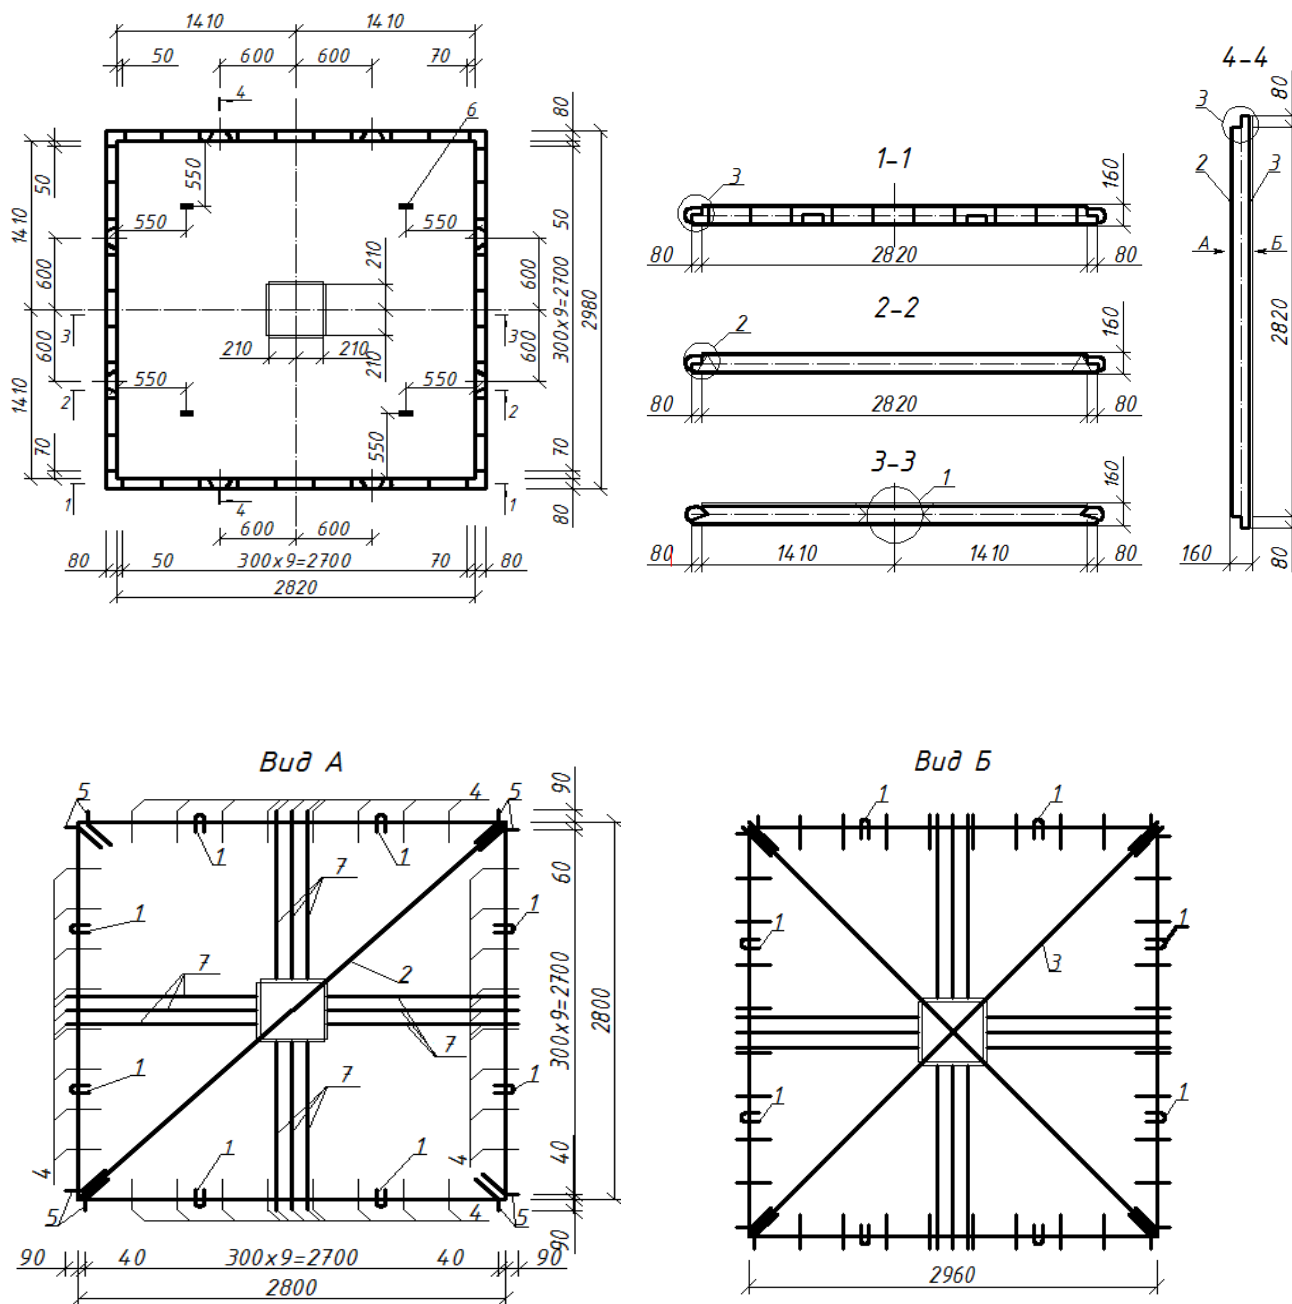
Опалубкове креслення та схема армування надколонної плити ПН 30.30.1,6-2-1:
